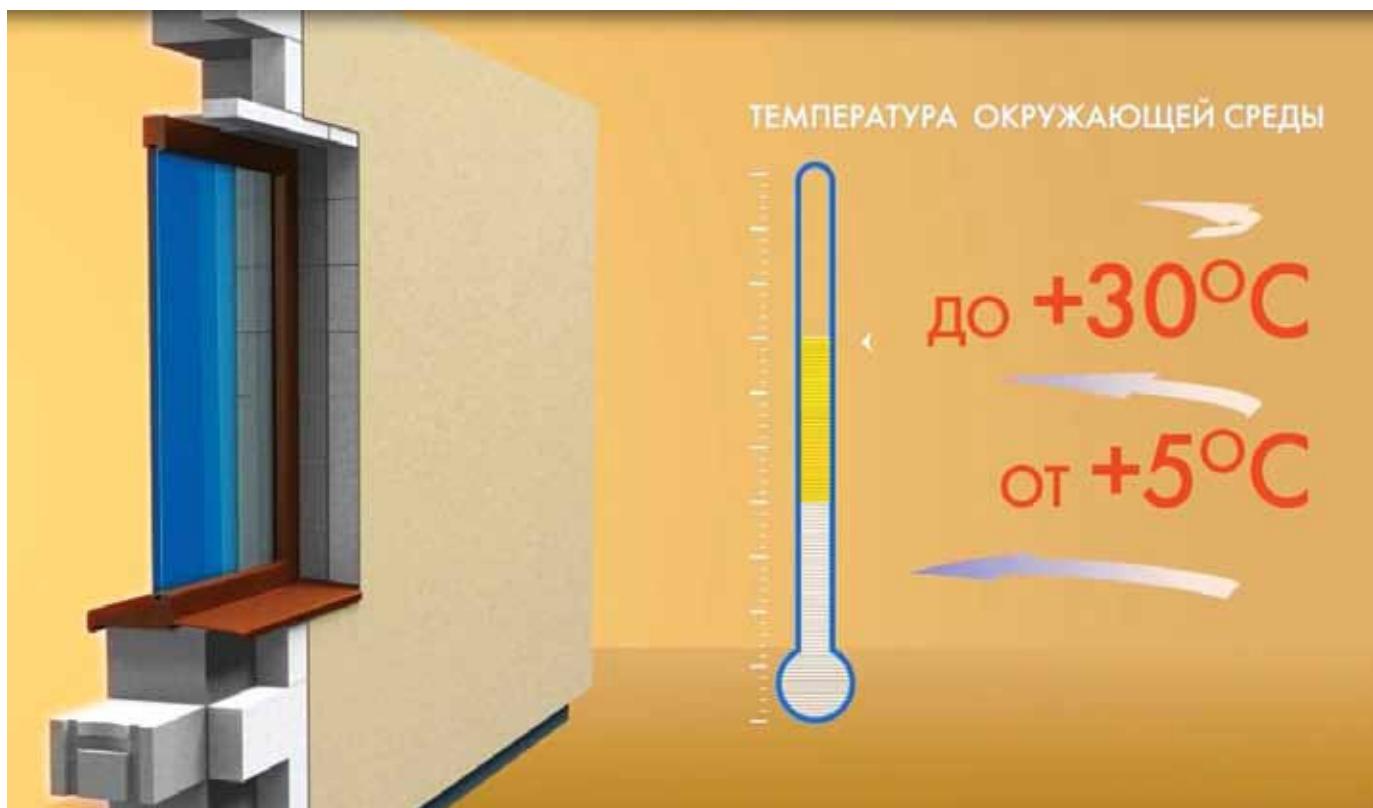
Необходимые условия для выполнения работ по устройству наружной системы изоляции AERO Energy
